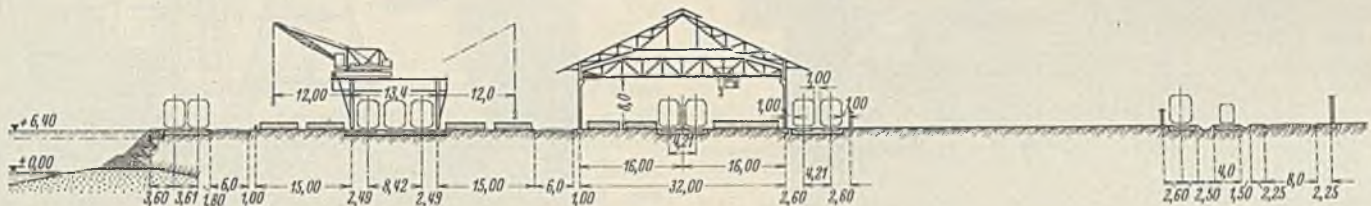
Bordeaux. Umschlaganlage für Kolonialhölzer in Bassens Amont.
